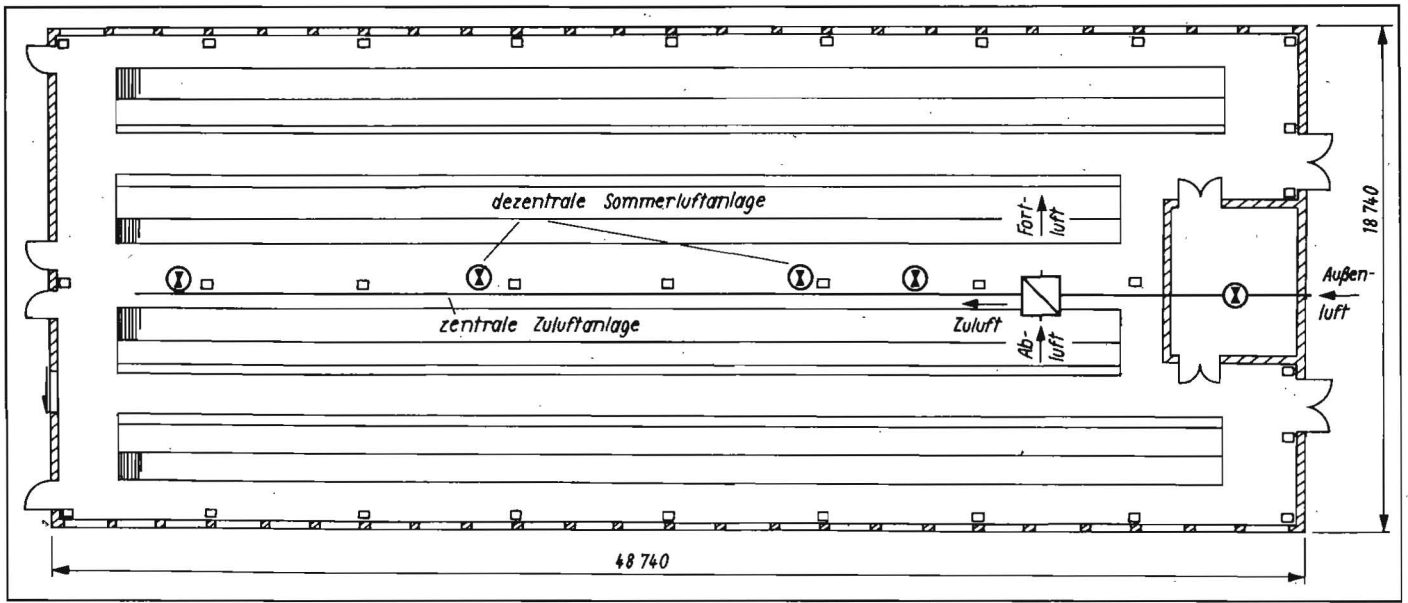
Grundriß des Sauenstalls mit Prinzipdarstellung der Stalllüftungsanlage
